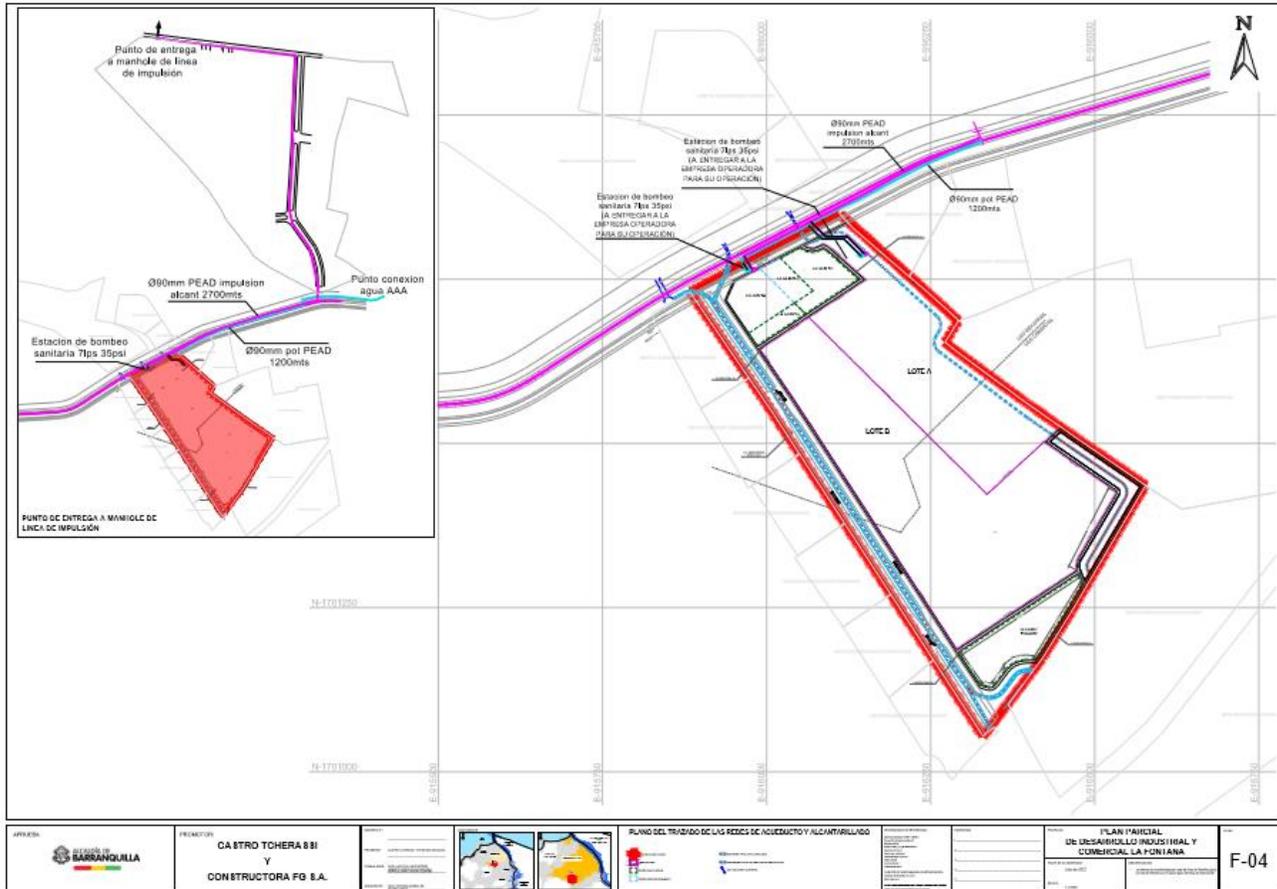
trazado de redes de acueducto y alcantarillado.
